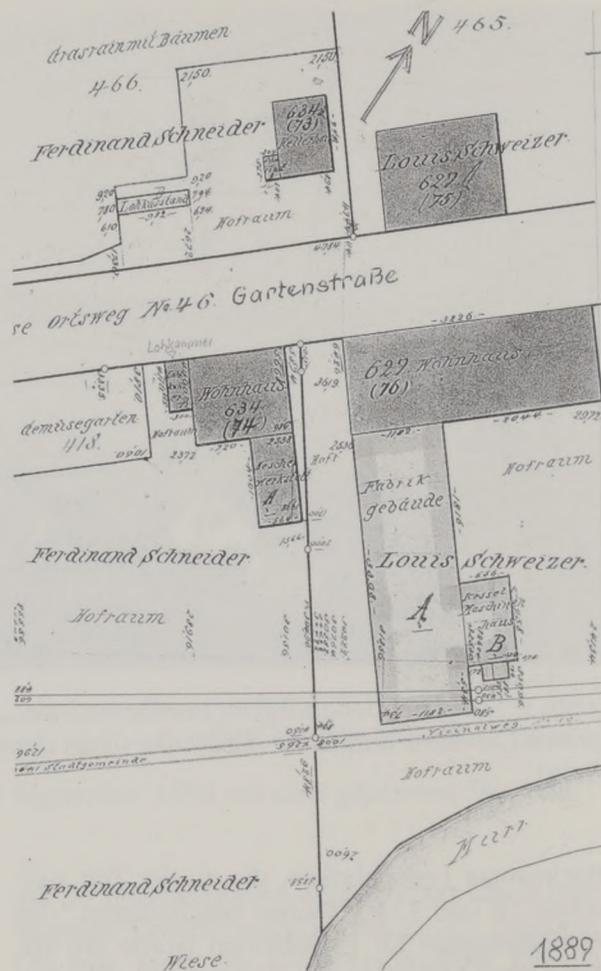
Lageplan der Rotgerberei Ferdinand Schneider sen., Gartenstraße 73/74 im Jahr 1889.
